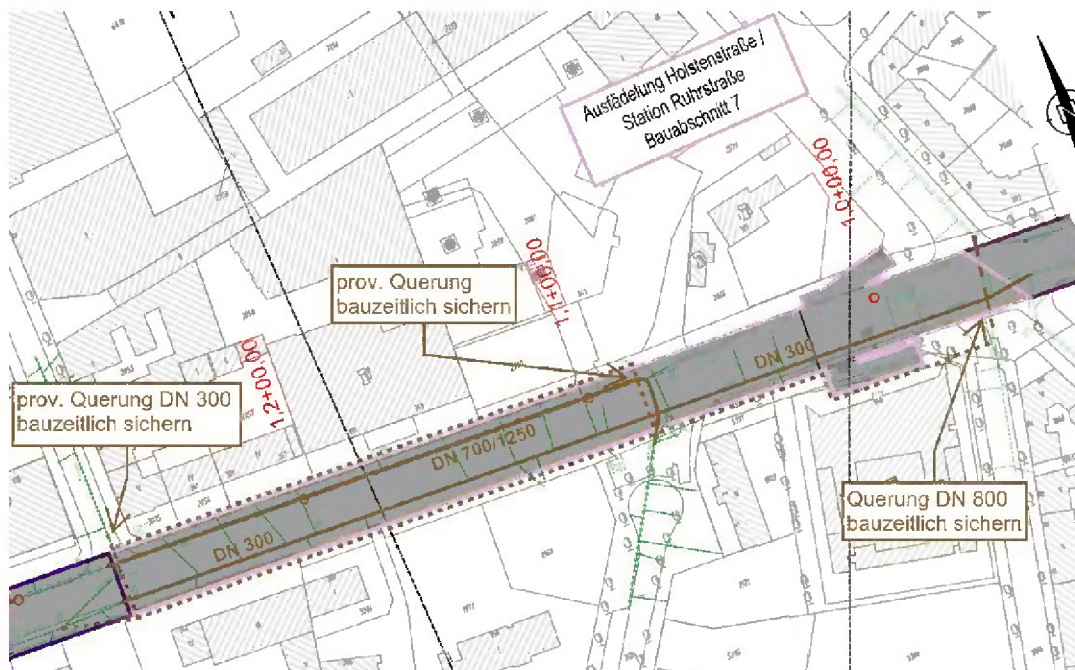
Sielplan Baubereich Station Ruhrstraße und Weichentrapez, Bauabschnitte 7 (Stand 04.2019)
